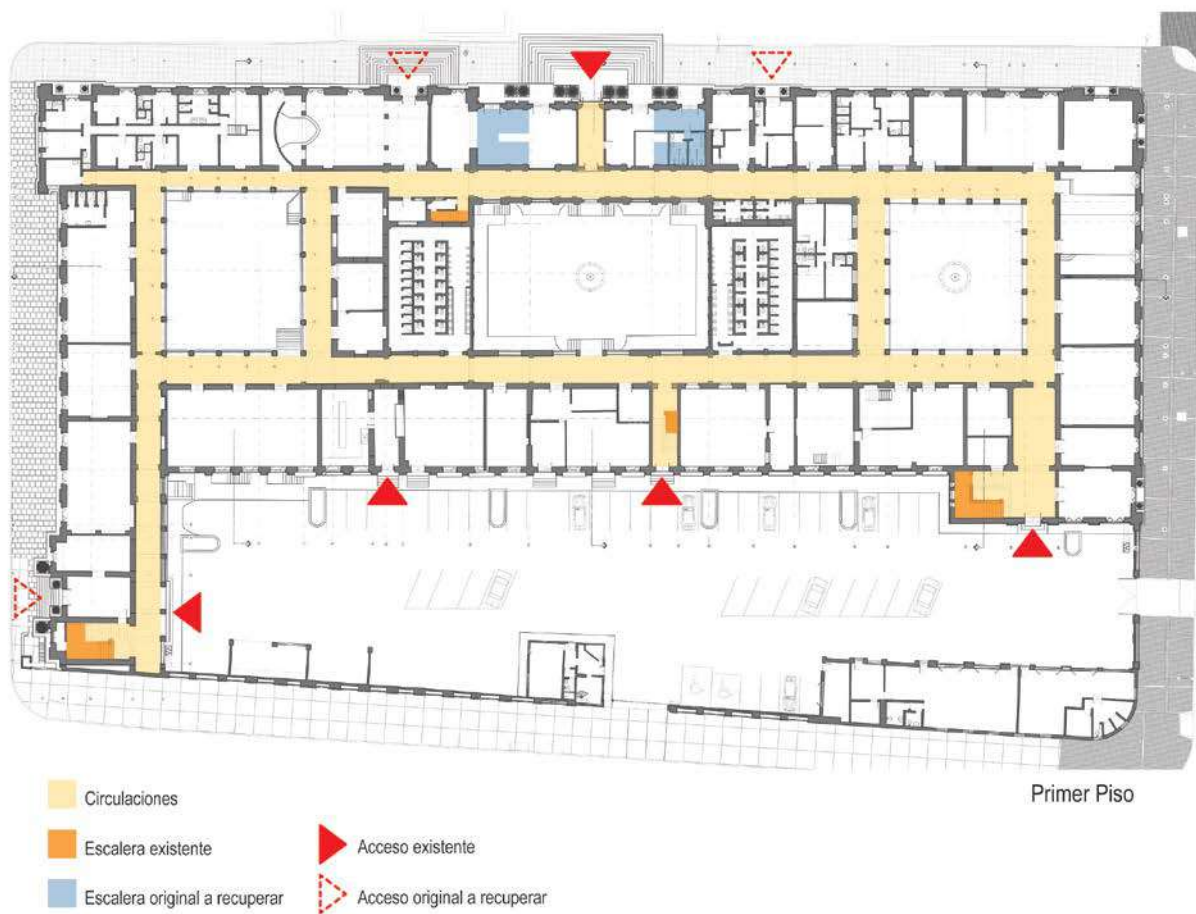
Plano Planta De Primer Piso esquema de accesos circulaciones y escaleras
